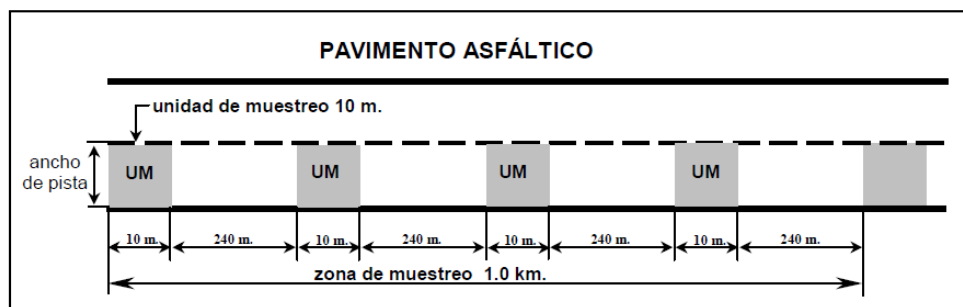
Unidad y Zona de Muestreo para Pavimento Asfáltico, Fuente: Instructivo de Inspección Visual de Caminos Pavimentados, 2010.
